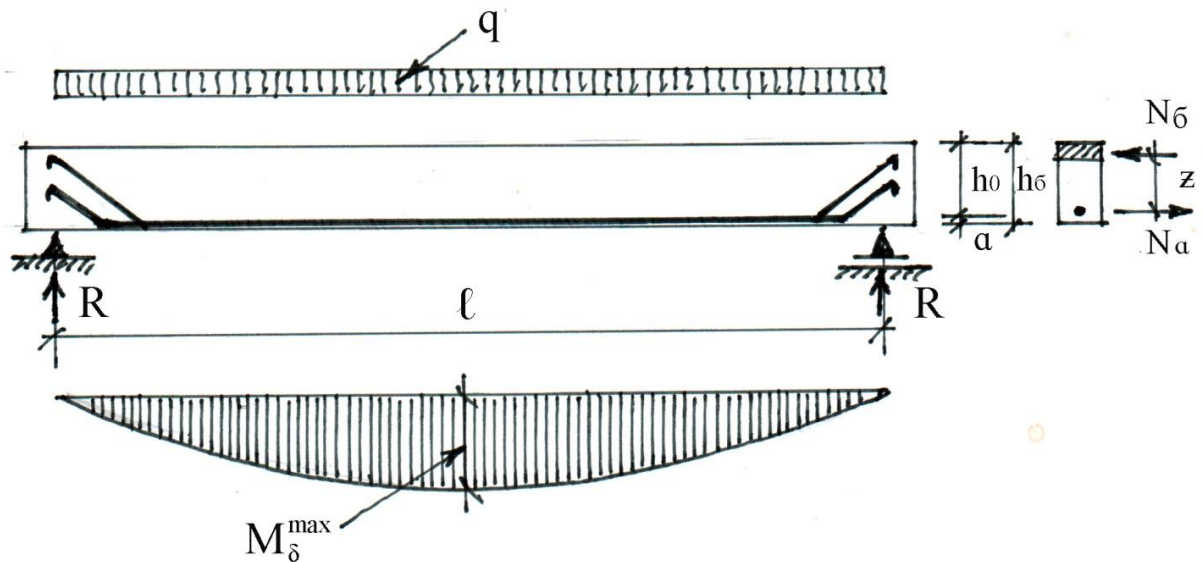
Конструкция однопролётной железобетонной балки с классическим одиночным армированием
